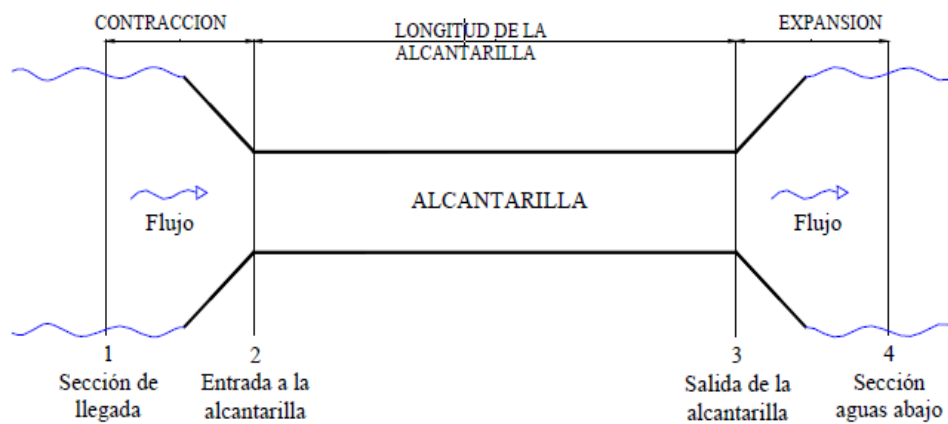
VISTA EN PLANTA DE UNA ALCANTARILLA
